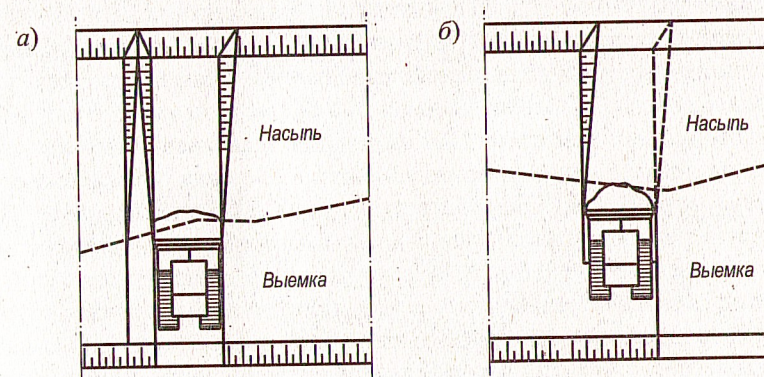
Схемы резания и перемещения грунта бульдозером: а — планировка траншейным способом; б — то же послойным способом
